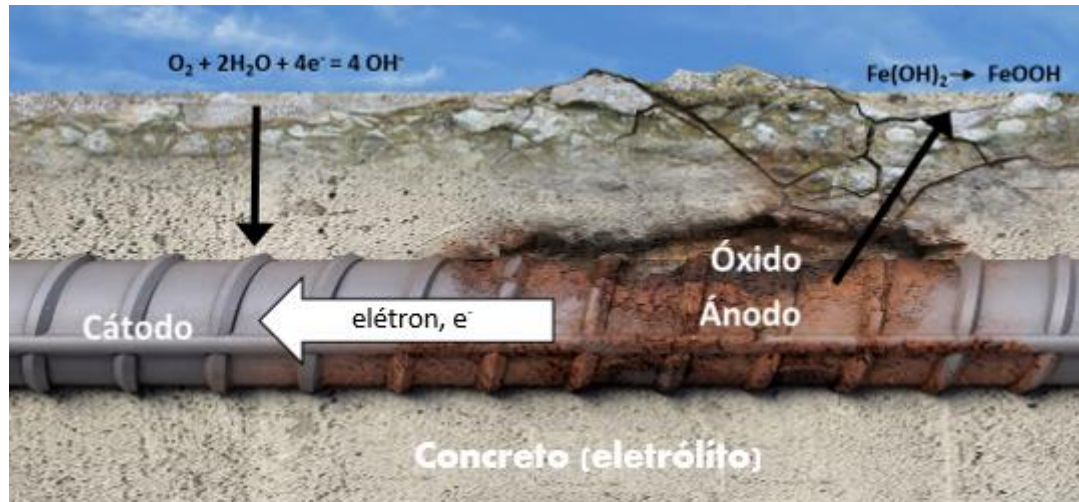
modelo esquemático da corrosão do aço da armadura no concreto.
